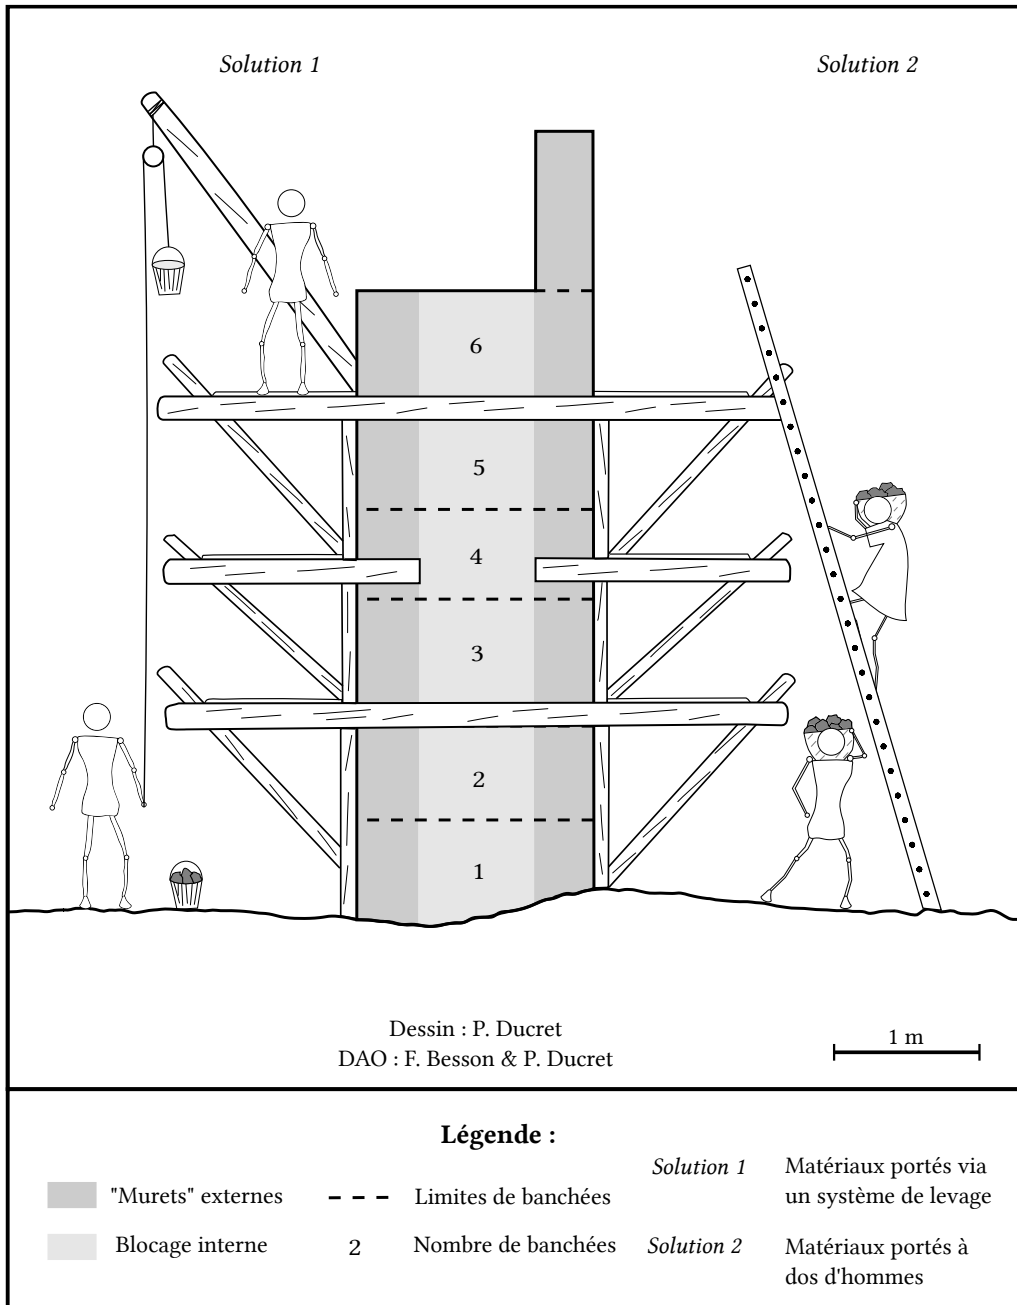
La muraille de Terracine : restitution schématique du chantier
